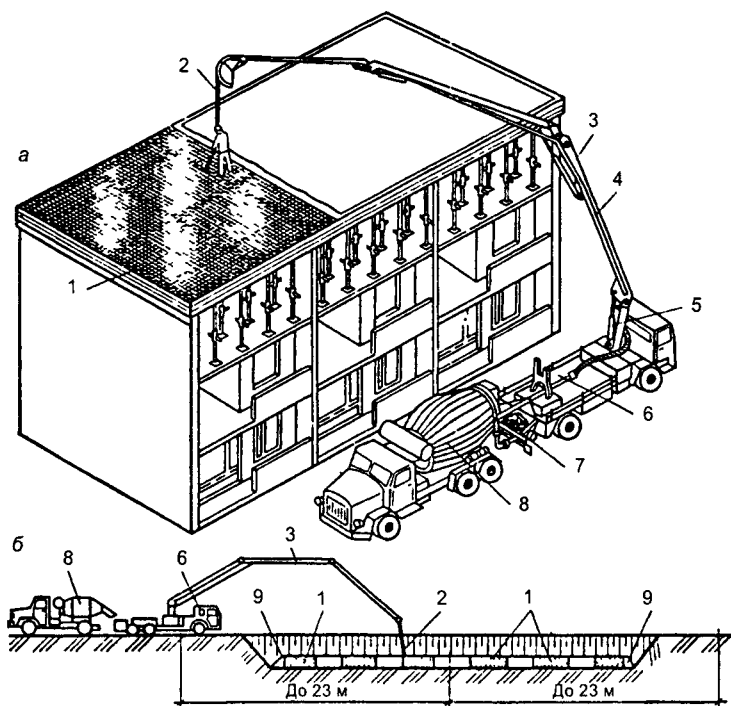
Укладка бетонной смеси автобетононасосами:
